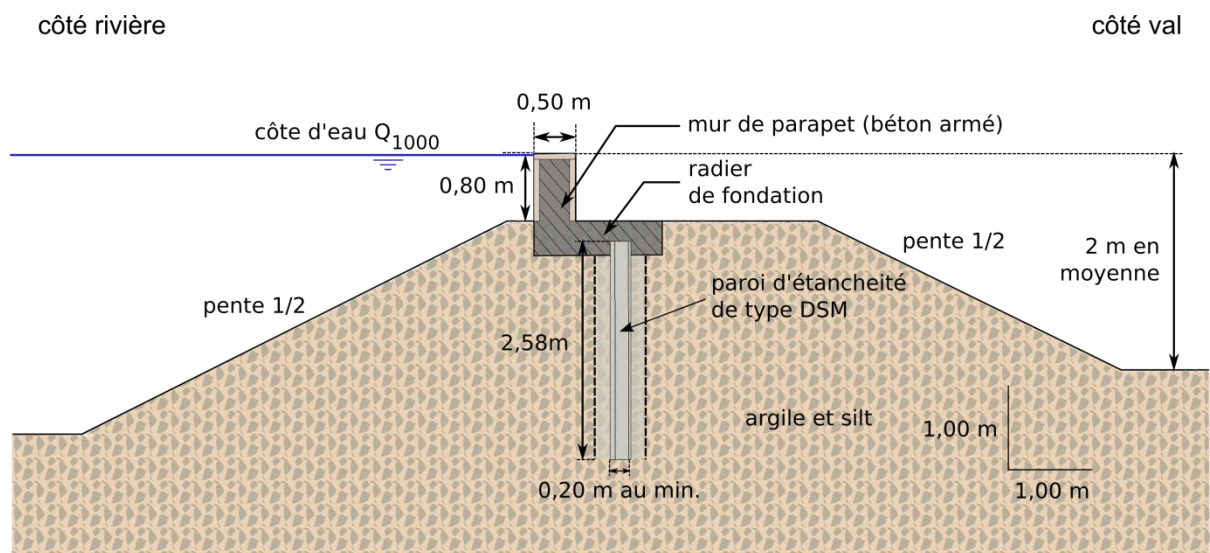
Surélévation d'une digue par un mur parapet
